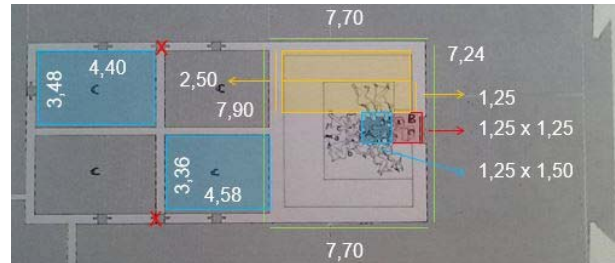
Le dimensioni e l'articolazione degli spazi nell'area dell'isolotto (rielaborazione su planimetria da Sanza Prina Ricotti 1979)
